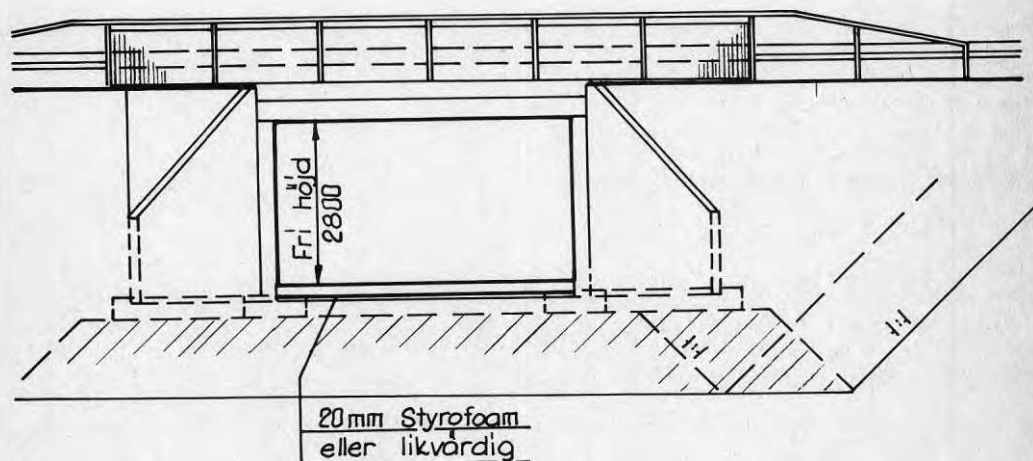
Tunnel ombyggd för  $h = 2,8$  m. Elevation 1:100
